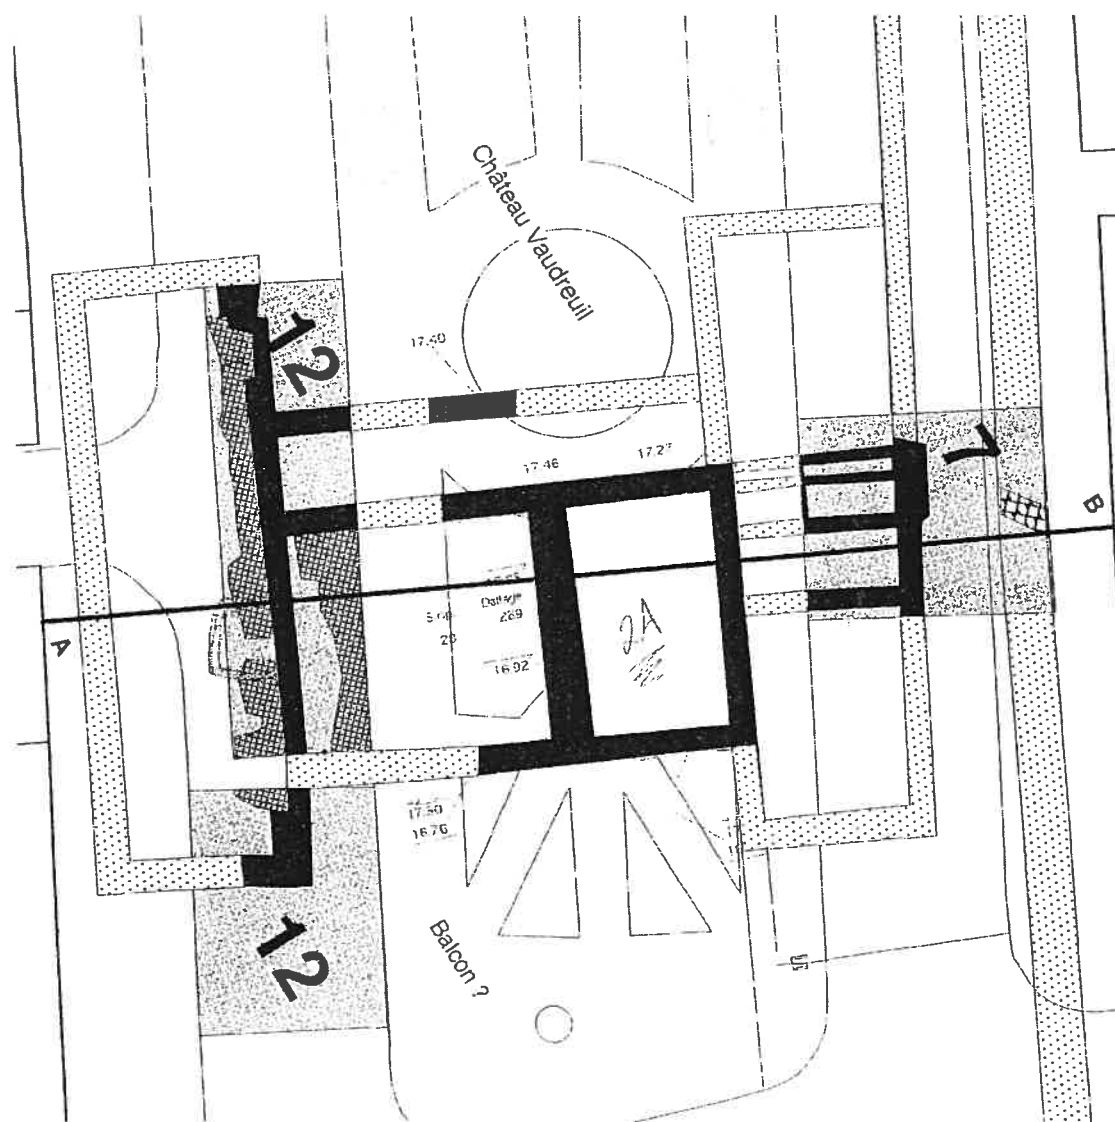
Plan du château avec les opérations 02, 07 et 12 (Plan de Archéotec Inc.)
